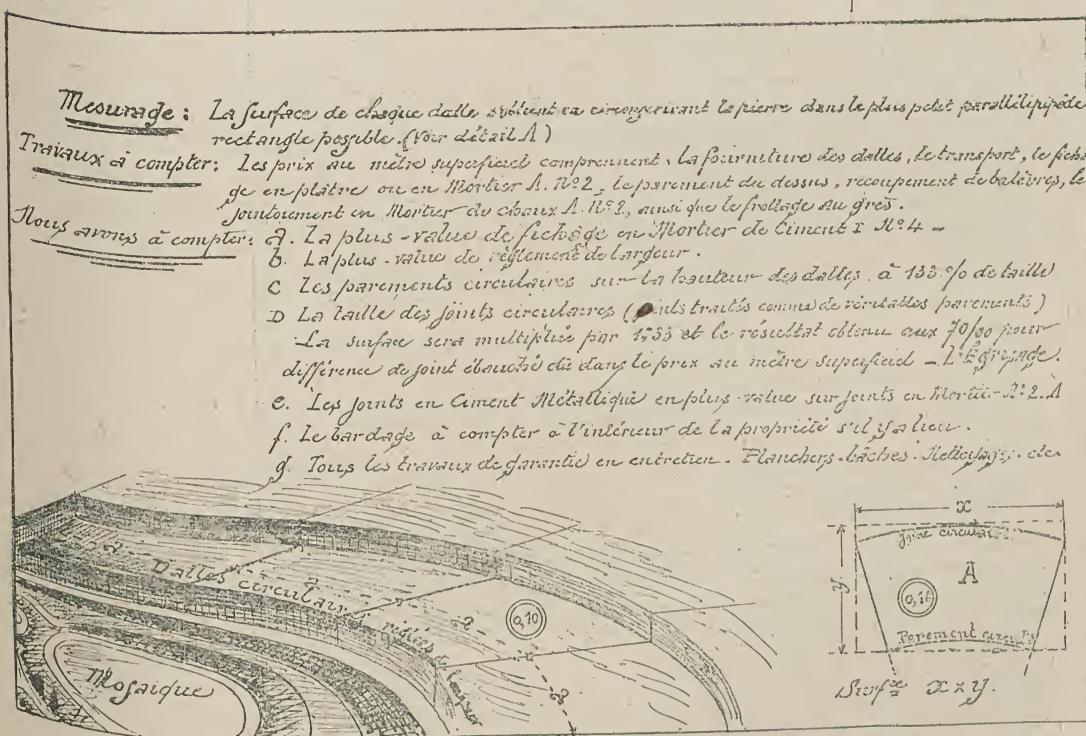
Perron en roche d'Ancy-le-Franc avec dalles circulaires réglées de largeur (en mortier de ciment li); les dalles égrissées; les joints en ciment métallique; la pierre taillée sur carrière.
